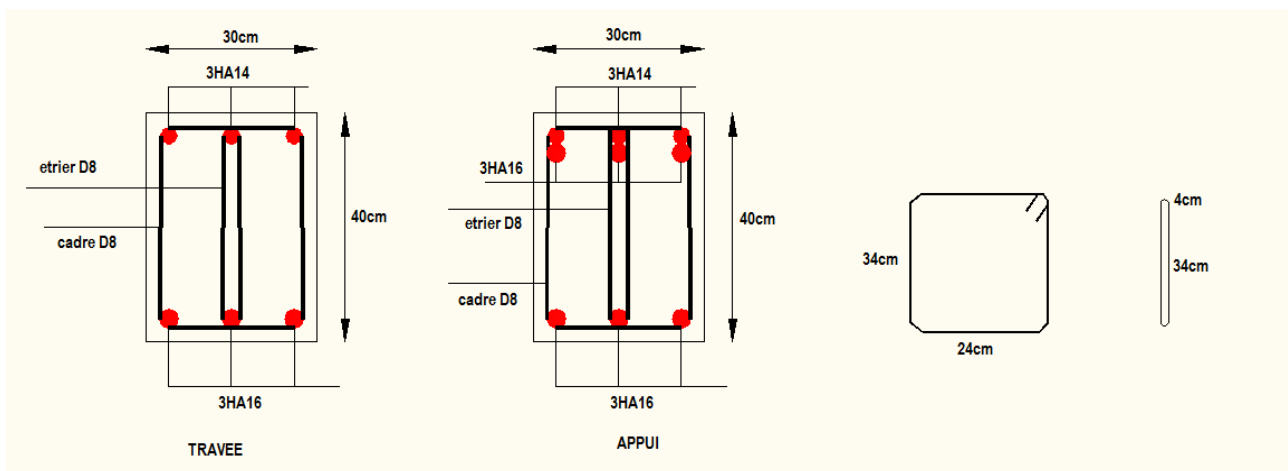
Schéma de ferrailage de la poutre principale du plancher RDC
